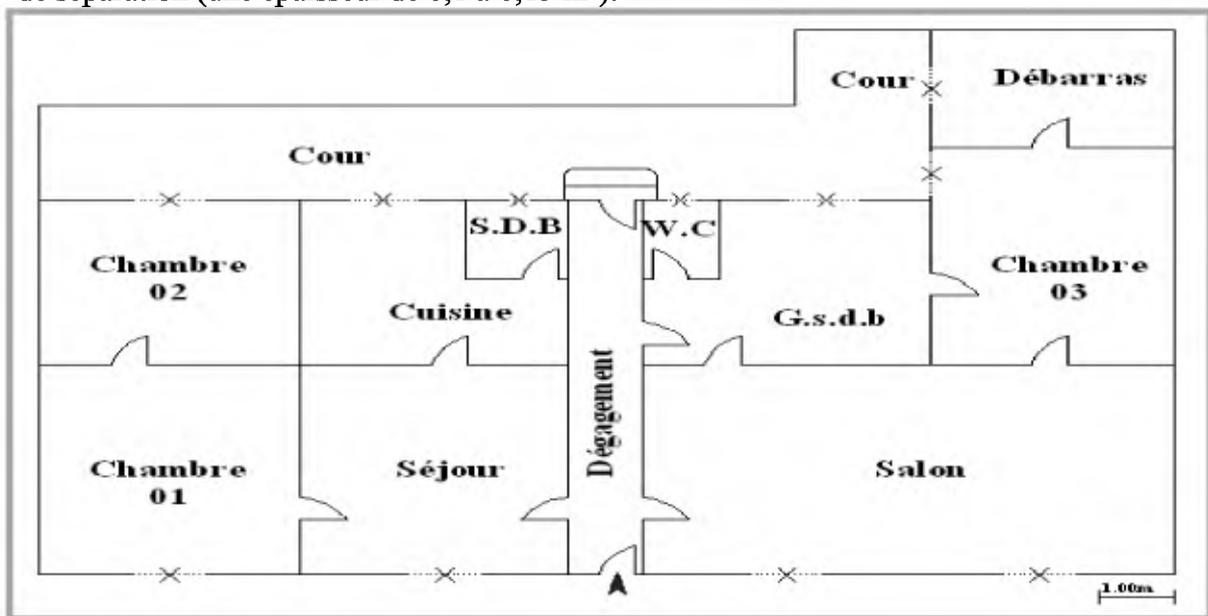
Plan d'une maison coloniale, habitat individuel
